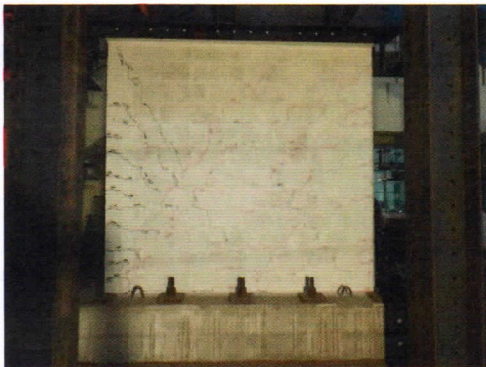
Nuevas grietas horizontales en la base del muro y en columnas para una distorsión 1/550 Vista cara Sur.
